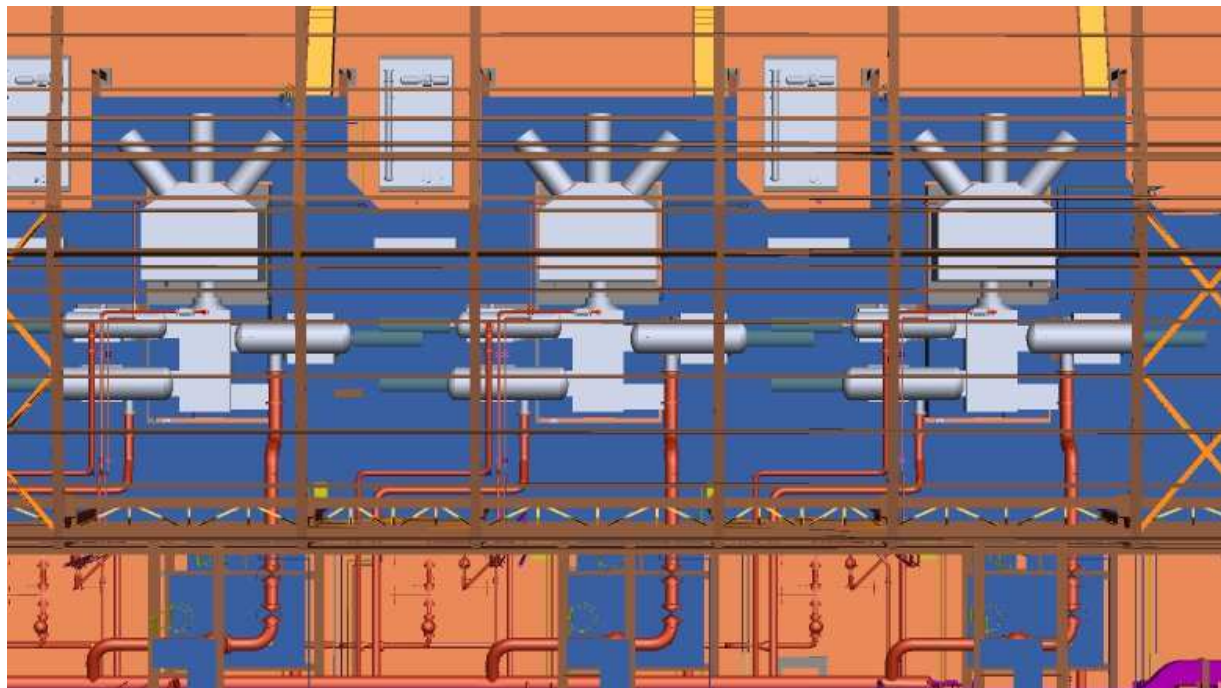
Disposición de Tuberías Alrededor de Compresores Alternativos- Vista en Planta
